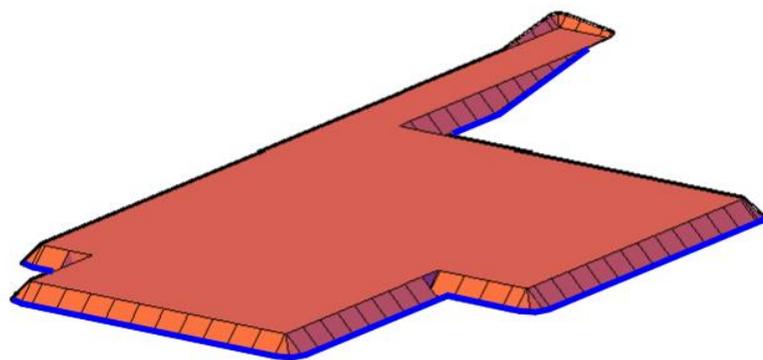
Stralcio planimetrico strada di ingresso alla NA01
